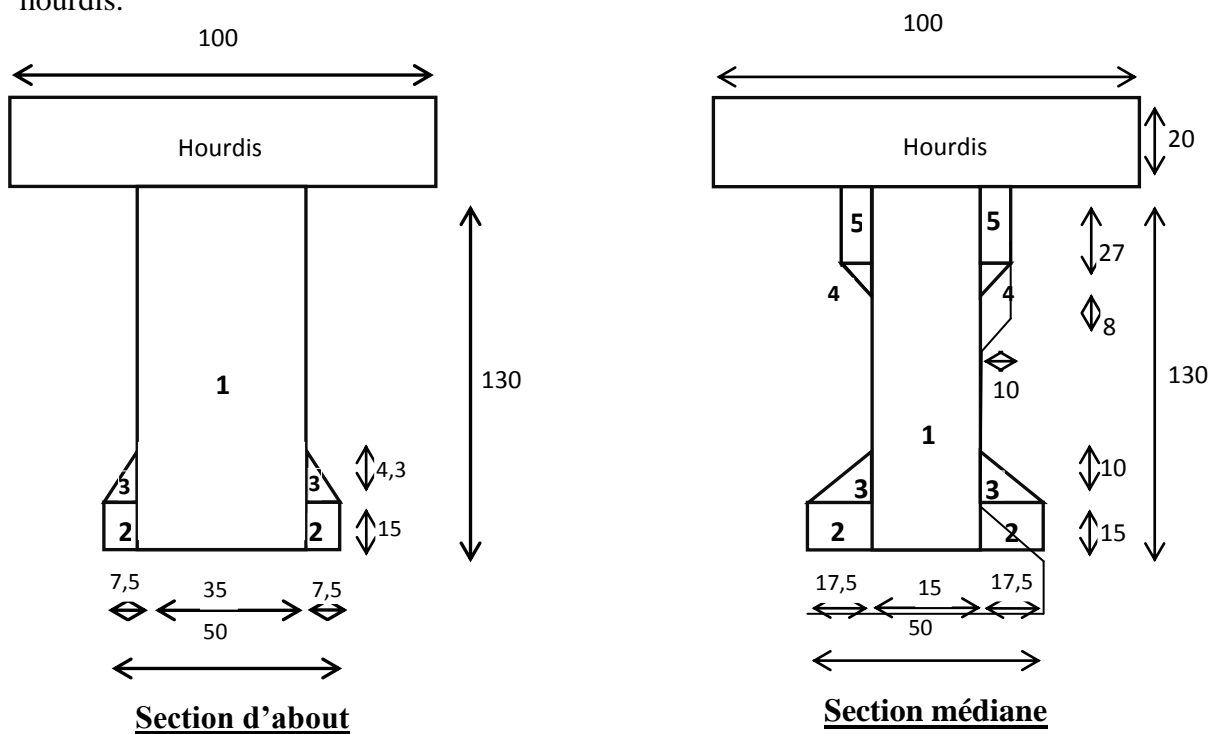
Dimensions de la poutre IM.3 S.A.P.T.A
